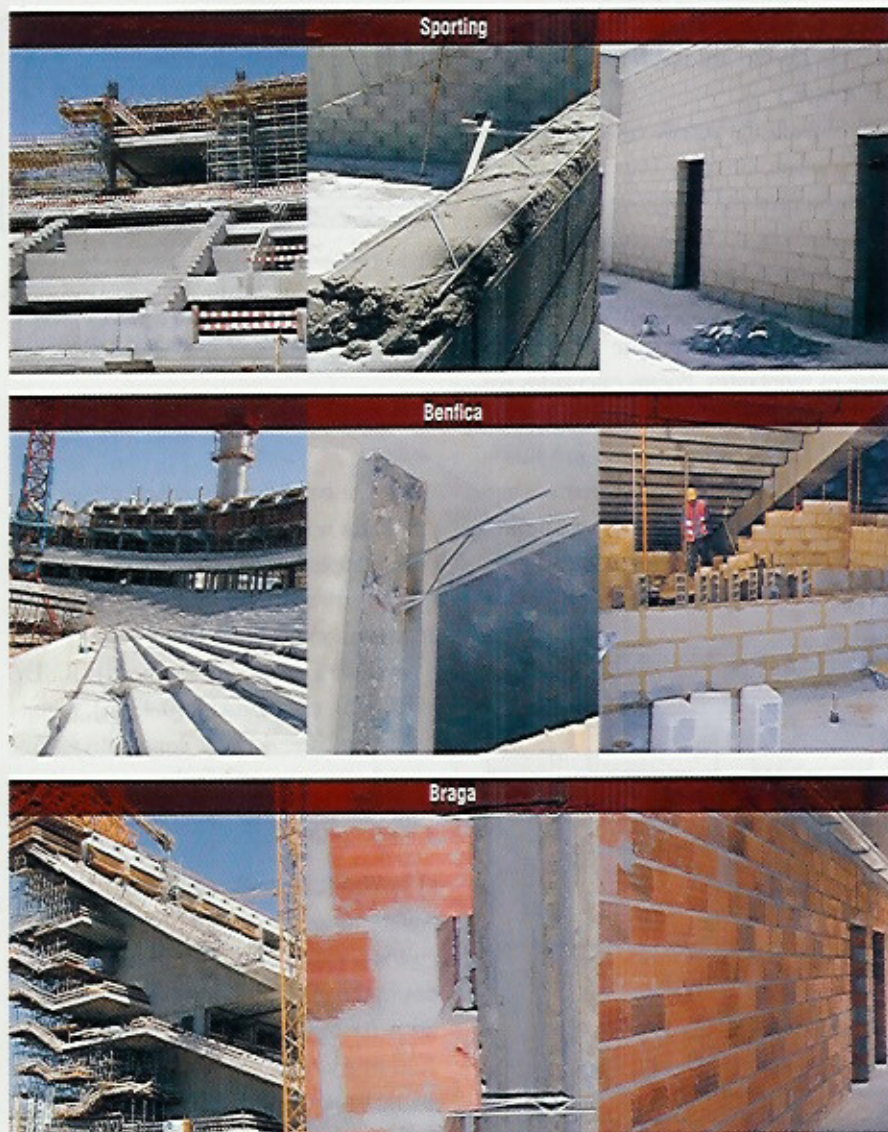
Imagens e detalhes dos estádios do Euro 2004 com soluções de armadura de junta Murfor®
